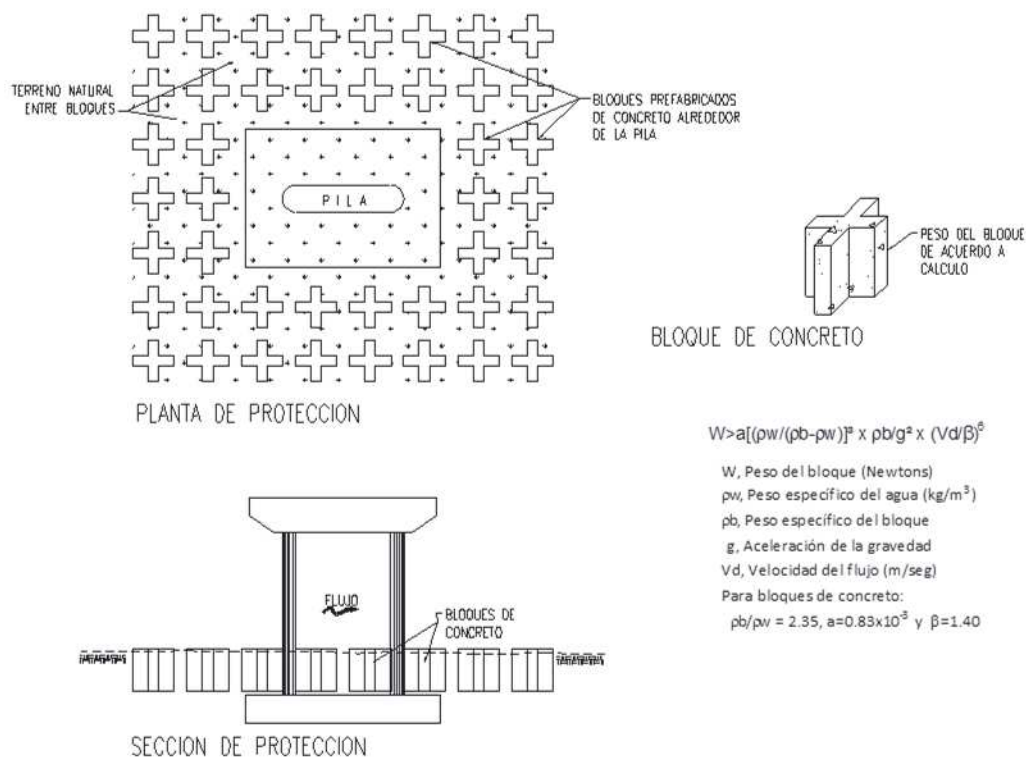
Protección local en pilas mediante bloques prefabricados de concreto. (SPOP, 2014)
